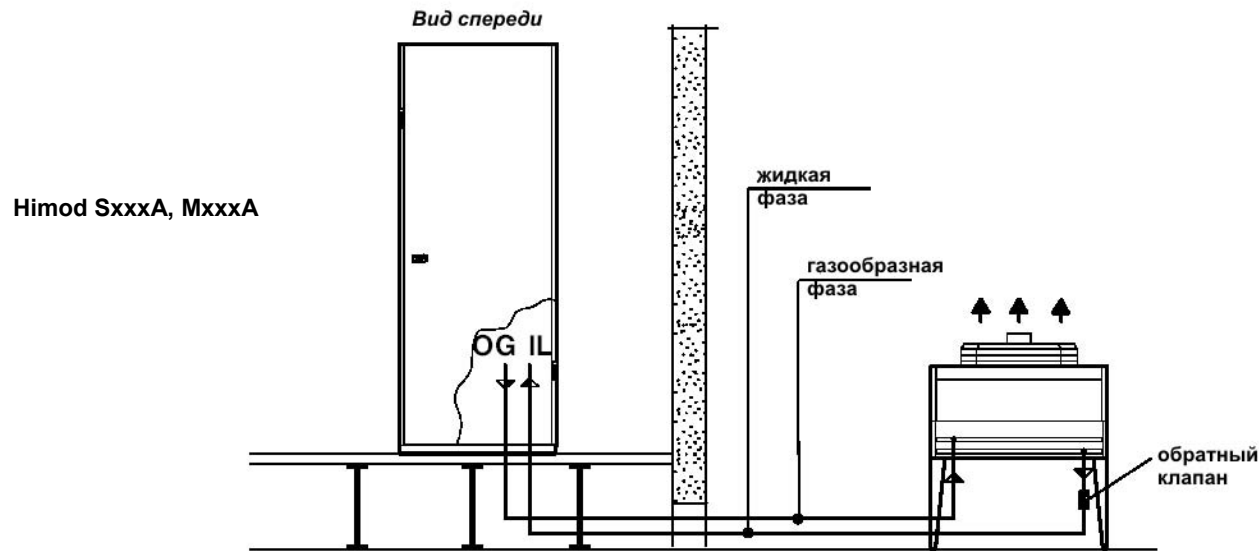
Внешние соединения блока Himod M 34...66: Хладагентный и гидравлический контура, электропроводка.
